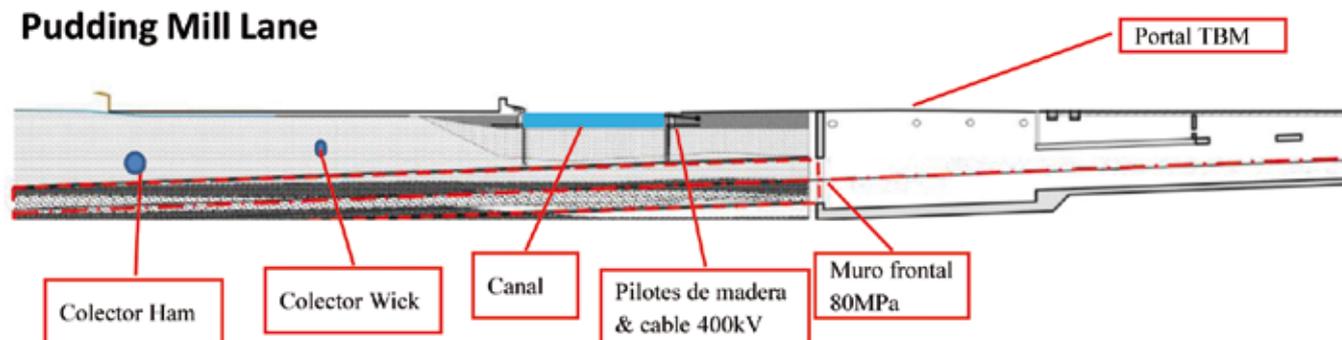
Sección longitudinal de los túneles en la zona de Pudding Mill Lane
